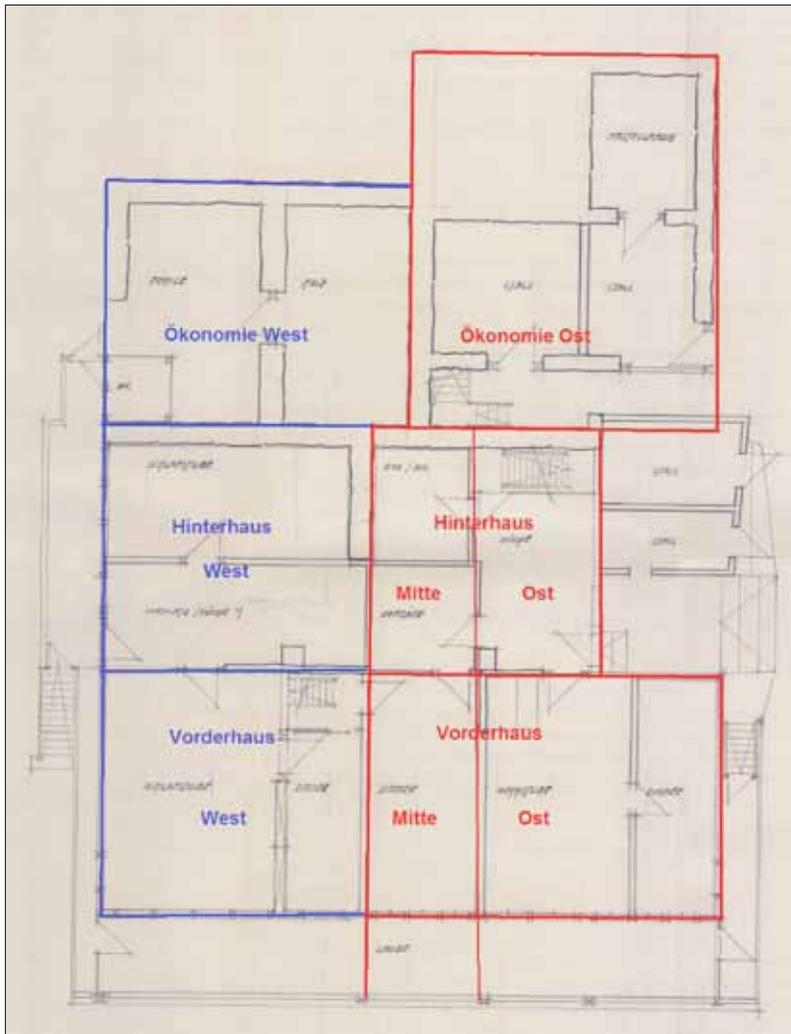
Grundriss des Erdgeschosses mit Eintrag der unterschiedlichen Hausteile.
